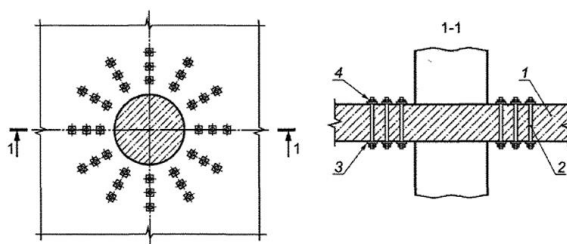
Схема усиления плит с помощью дополнительной поперечной арматуры:
